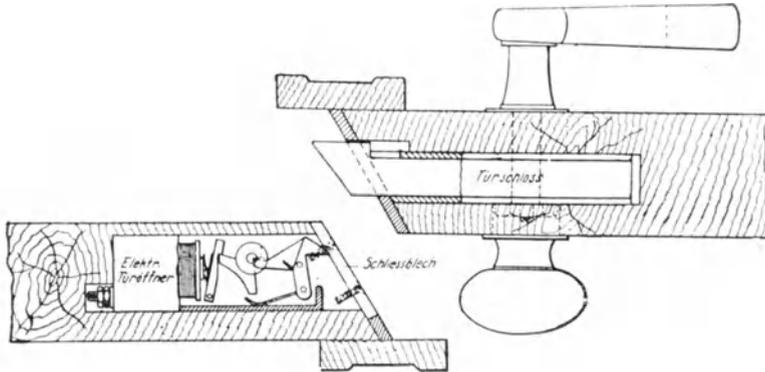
Montageanordnung des Türöffners für Holztüren.
